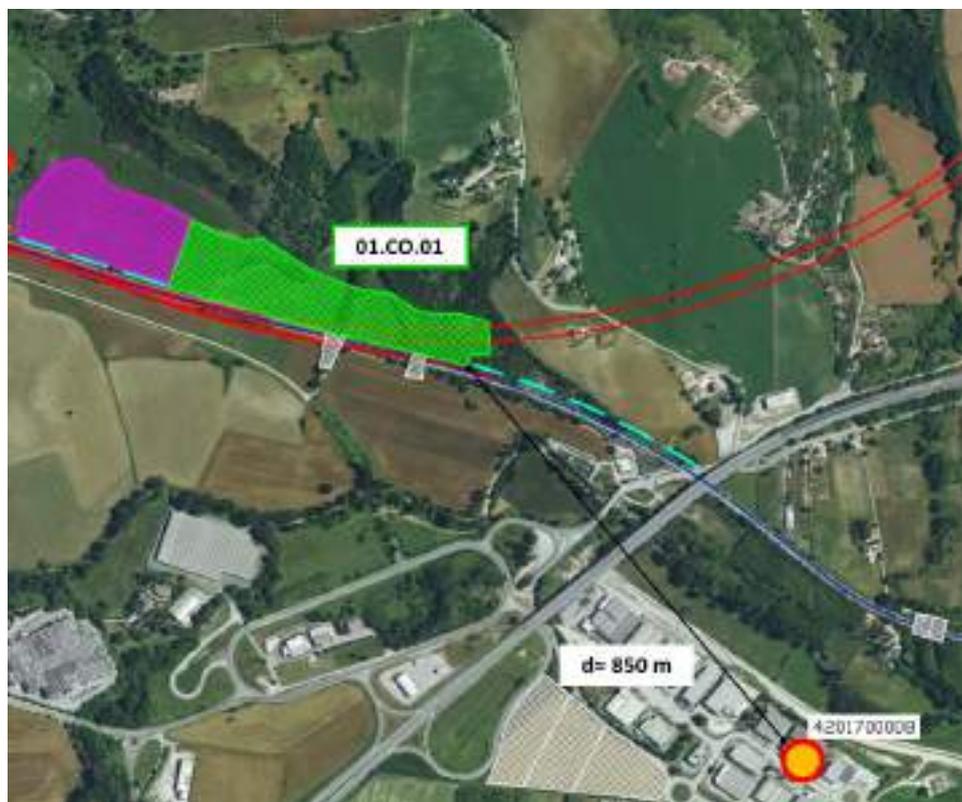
Aree cantiere rispetto al sito contaminato (in verde il cantiere operativo; in fucsia l'area di stoccaggio)
